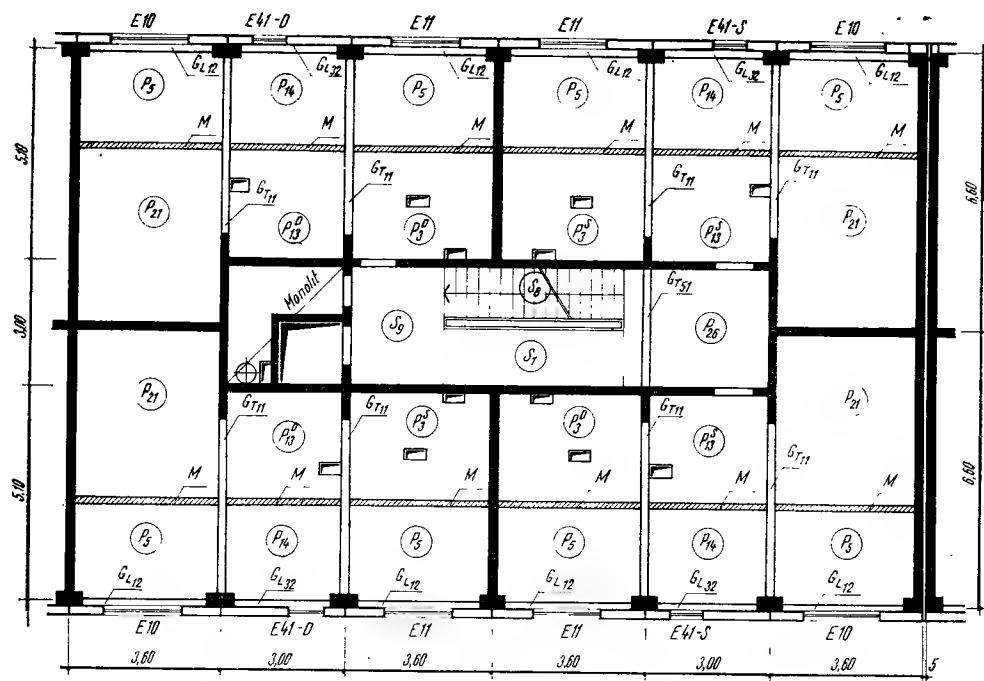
Plan poză prefabricate pentru o structură celulară, P + 10E, alcătuită din diafragme și stâlpi din beton armat monolit, turnate în cofraje metalice plane, semipanouri prefabricate de planșeu care reazemă pe diafragme și pe grinzi prefabricate transversale și longitudinale și din panouri prefabricate pentru pereți exteriori:
